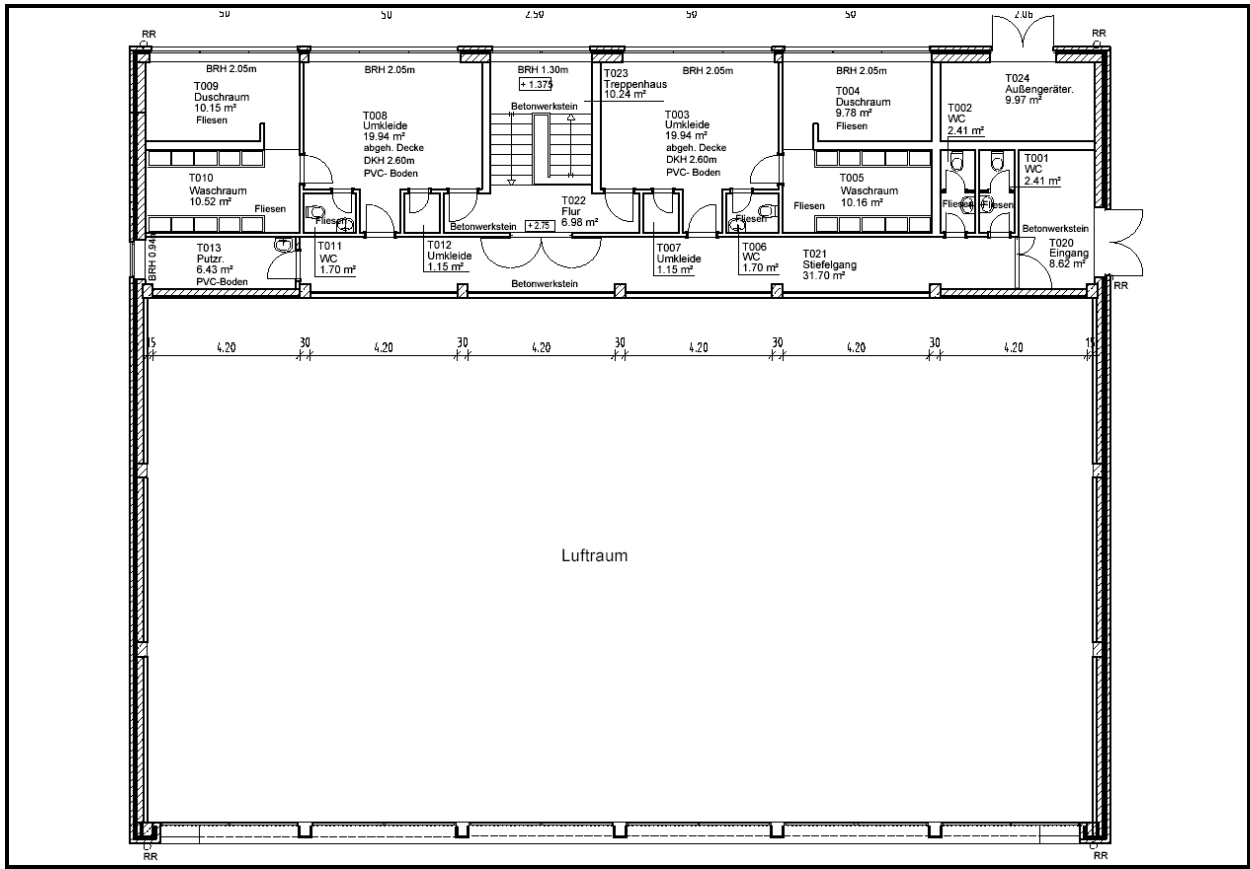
GS Am Clementinenhof: Grundriss Erdgeschoss Turnhalle
